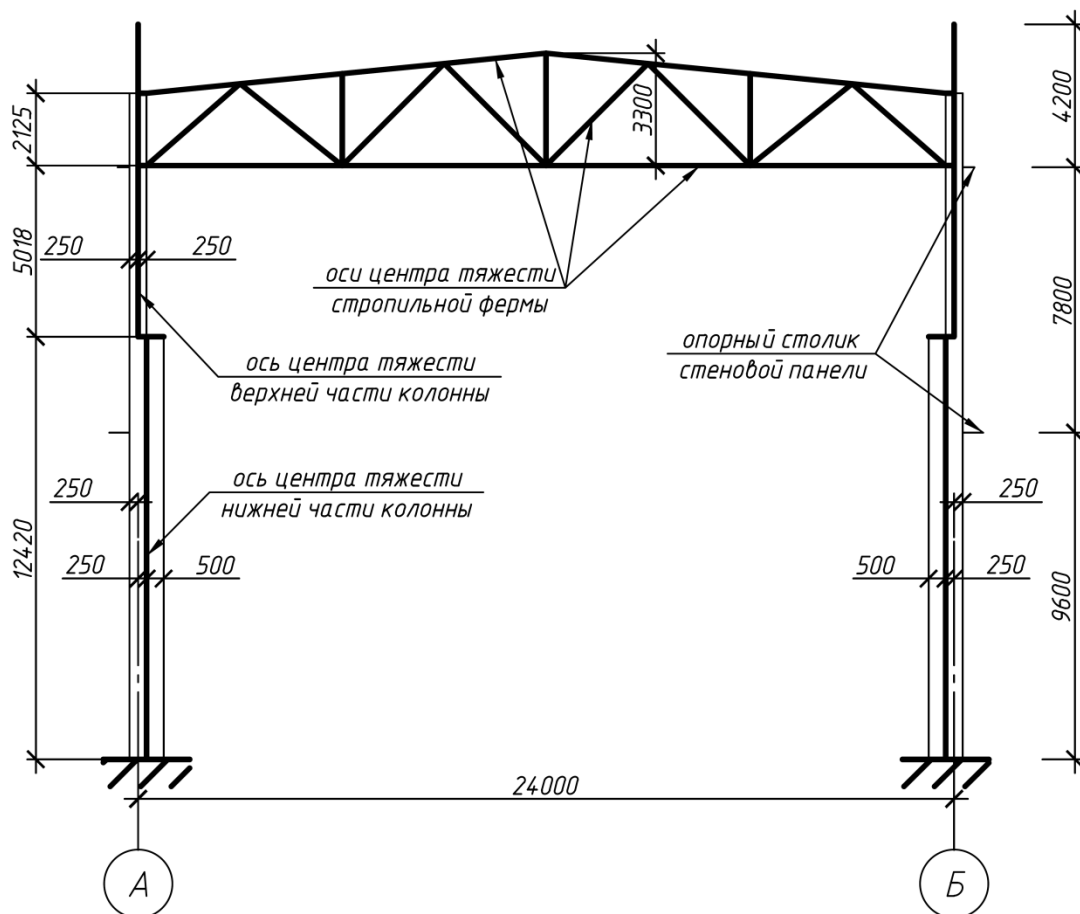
Расчетная схема поперечной рамы с жестким сопряжением ригеля с колонной
